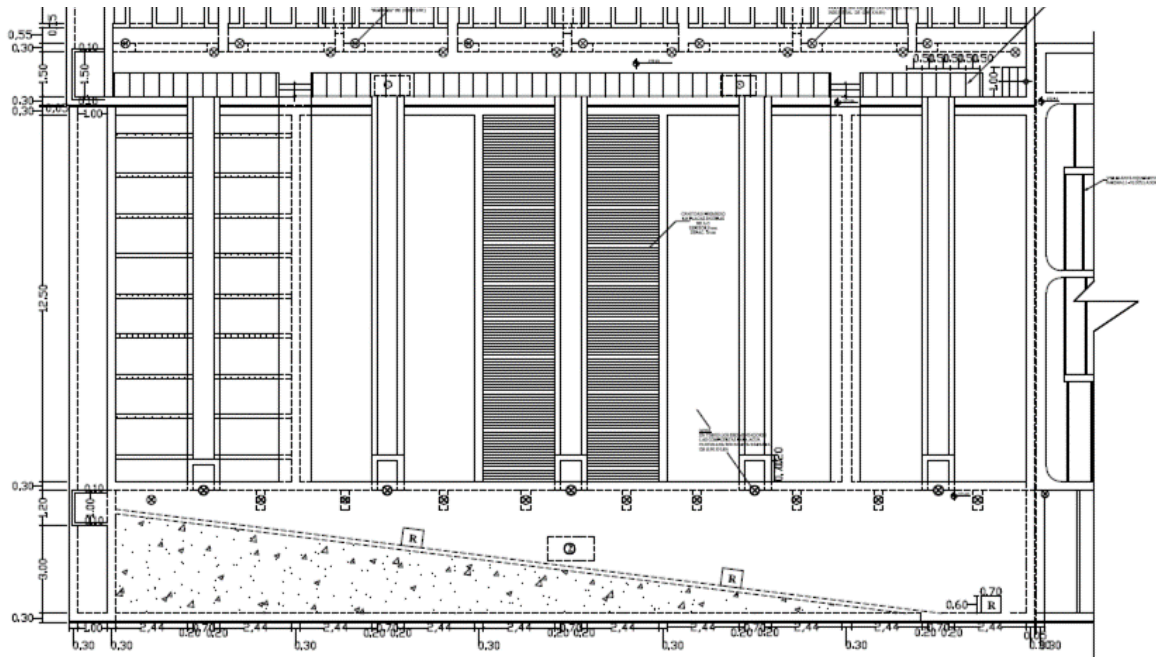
vista en corte y planta de los 5 decantadores de cada módulo de tratamiento
